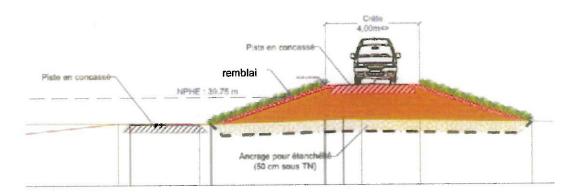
Extrait du plan de masse – Coupe en travers du corps d'ouvrage.
